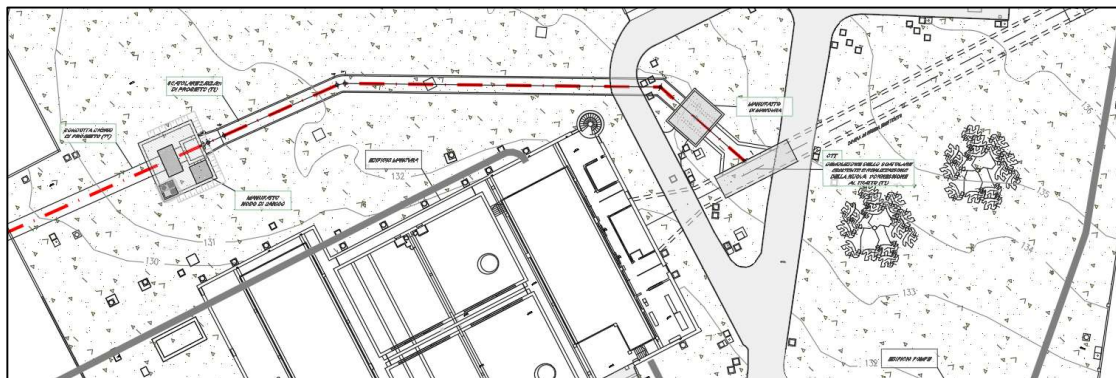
Planimetria di progetto del tratto TC1 interno al centro idrico esistente di Ottavia
